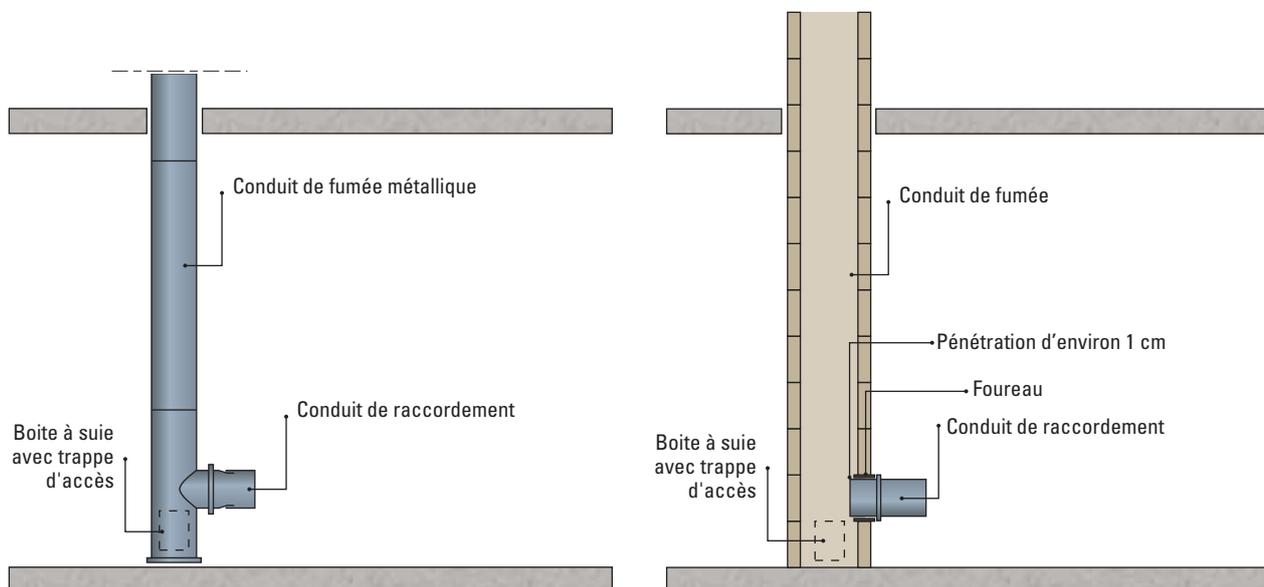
Exemples de raccordement horizontal sur un conduit de fumée départ au sol ou console
